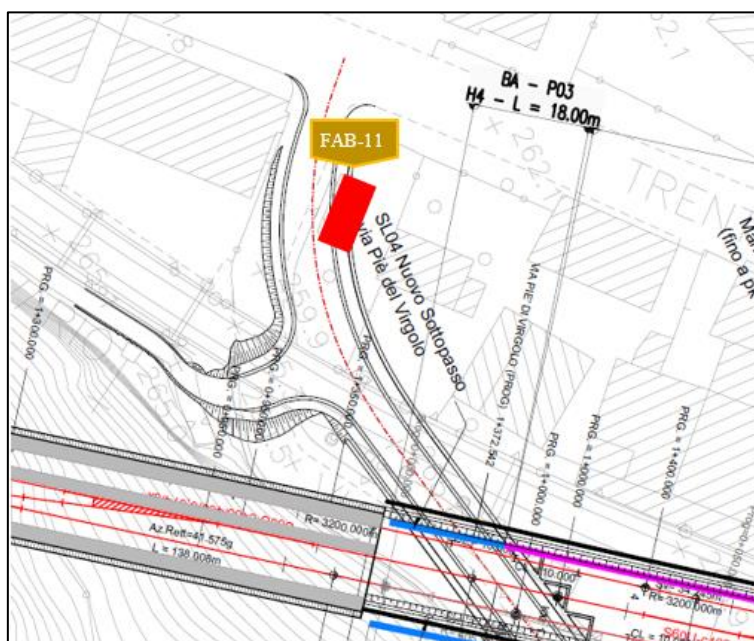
Stralcio planimetrico fabbricato via del Virgolo
